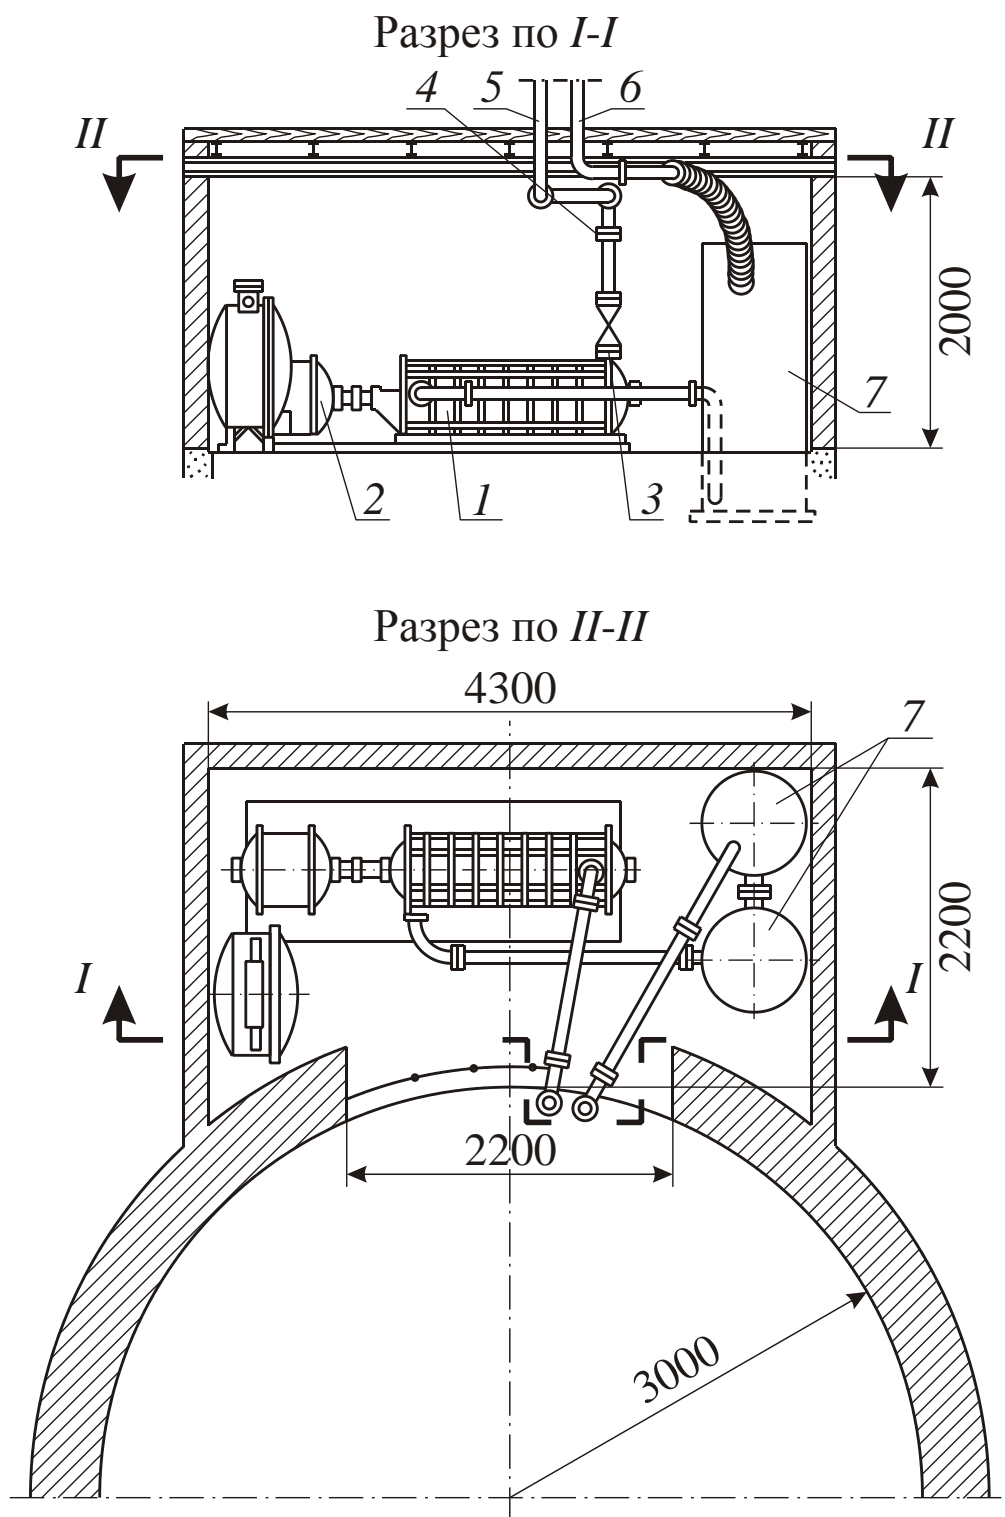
Схема перекачной насосной станции с металлическими водосборными баками:
